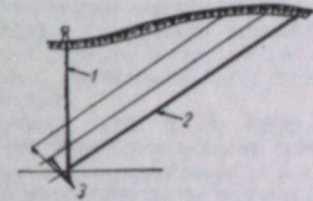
Бесквершлажная схема вскрытия блока гидрошахты.
